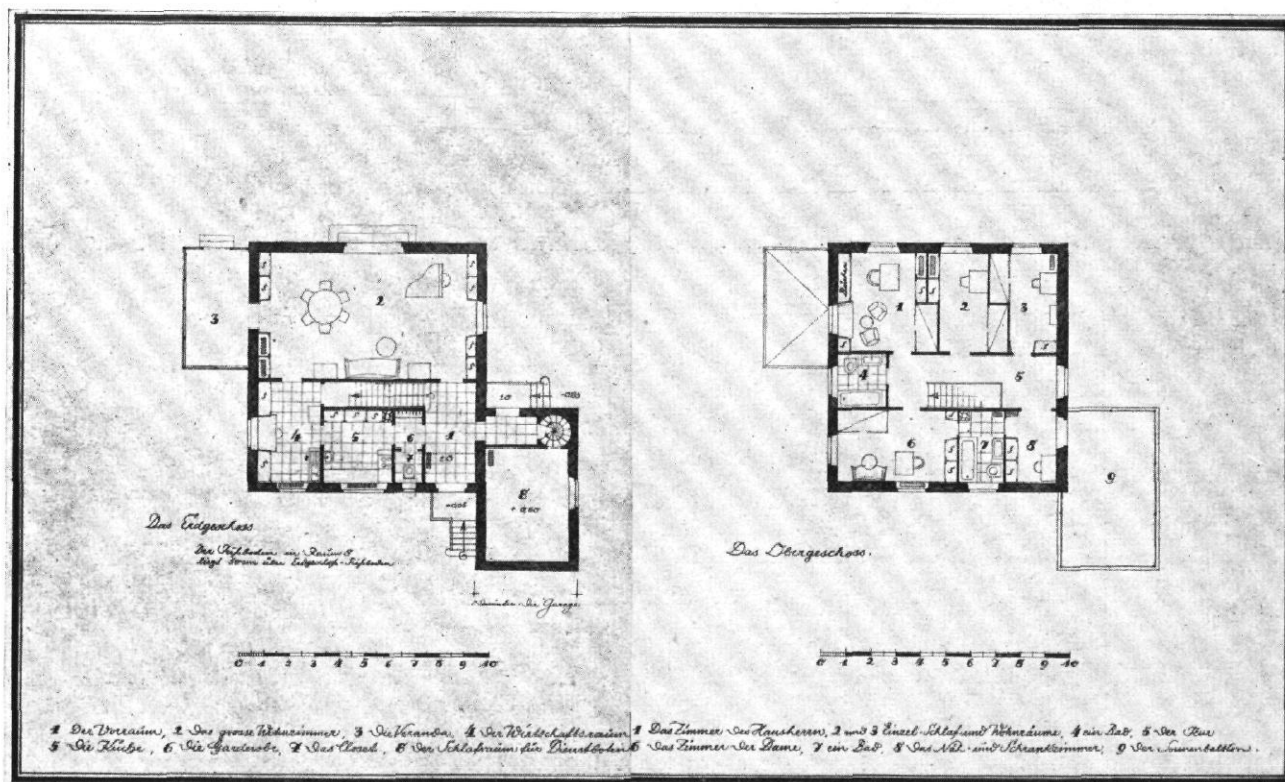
| Grundriß zu dem Wohnhaus Abbildung 76
